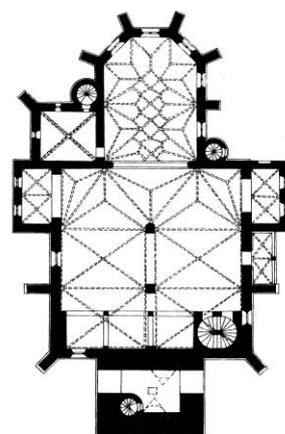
Kremnica, Katharinenkirche, Grundriss, 2. H. 14. Jh. bis 1488
